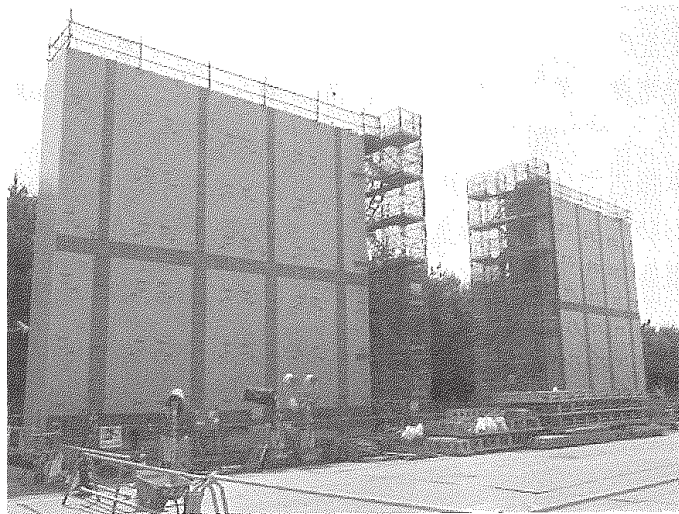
防波壁(たて壁)設置状況（事例シート3-4）
